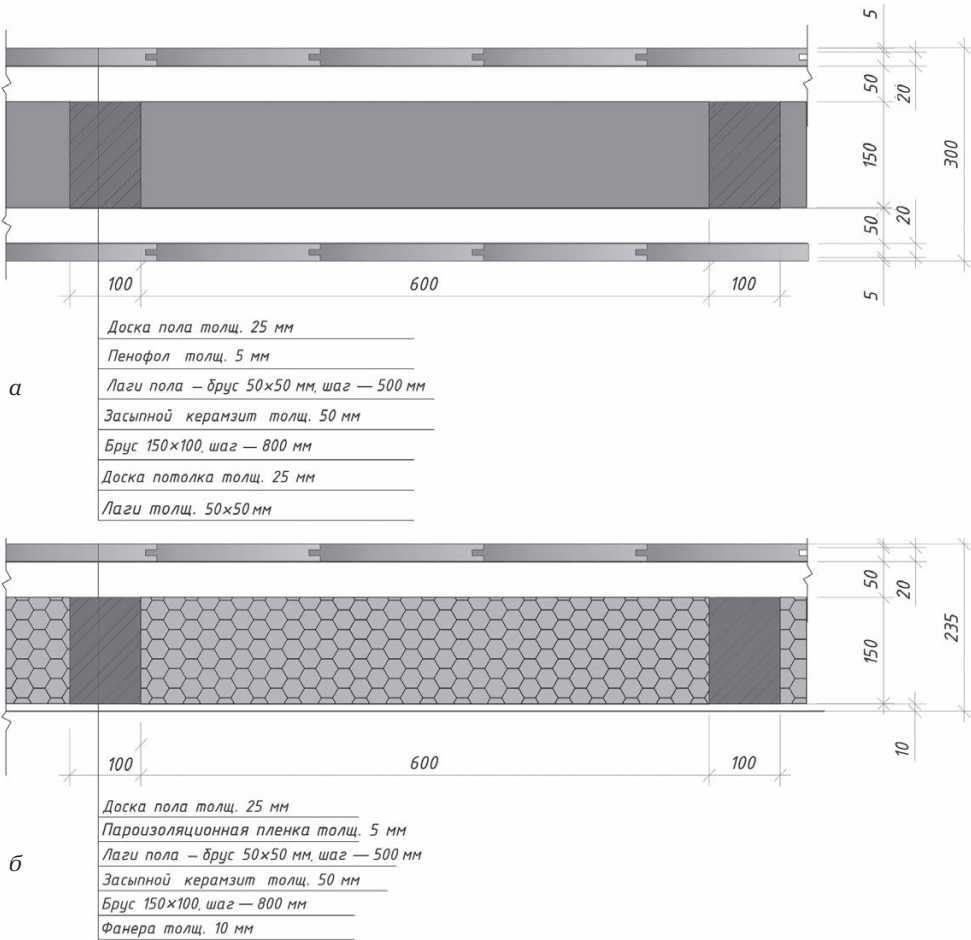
Утепление деревянных перекрытий: а — керамзитом; б — минераловатным утеплителем
